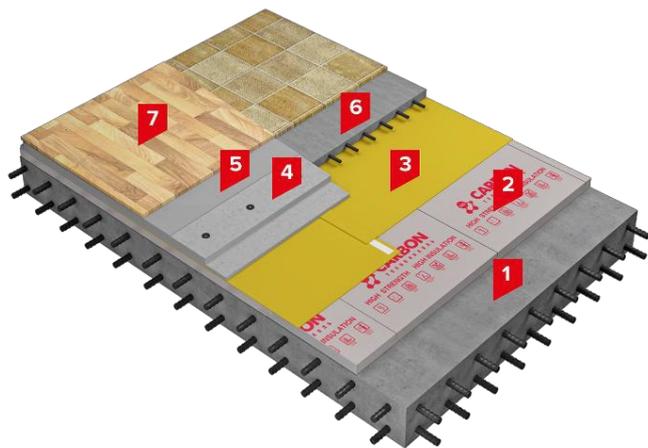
Конструктивное решение цокольного перекрытия над холодным подпольем:
